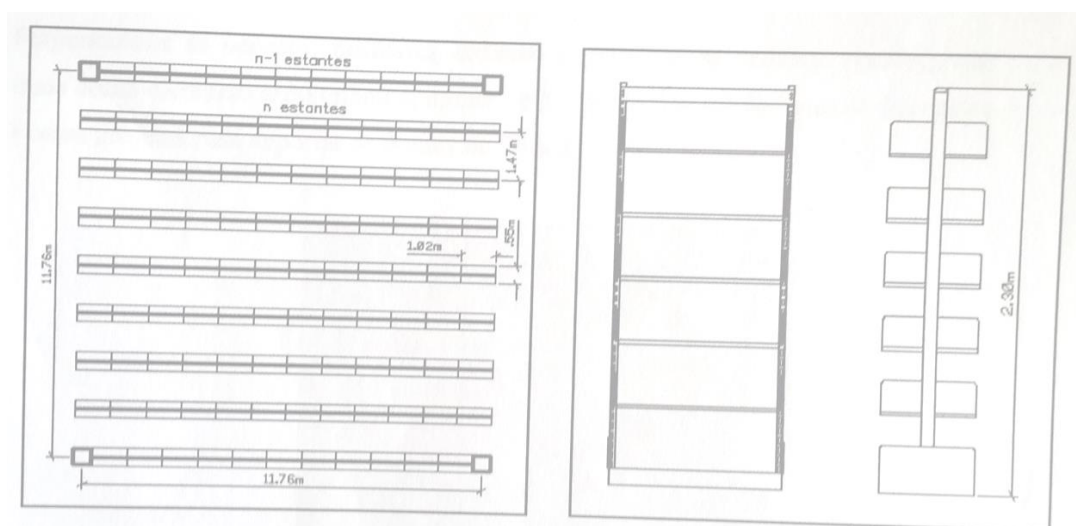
Concepção arquitetônica dos pilares e estantes de livros na BCE/UnB (Pena e Lourenço, 2008).
